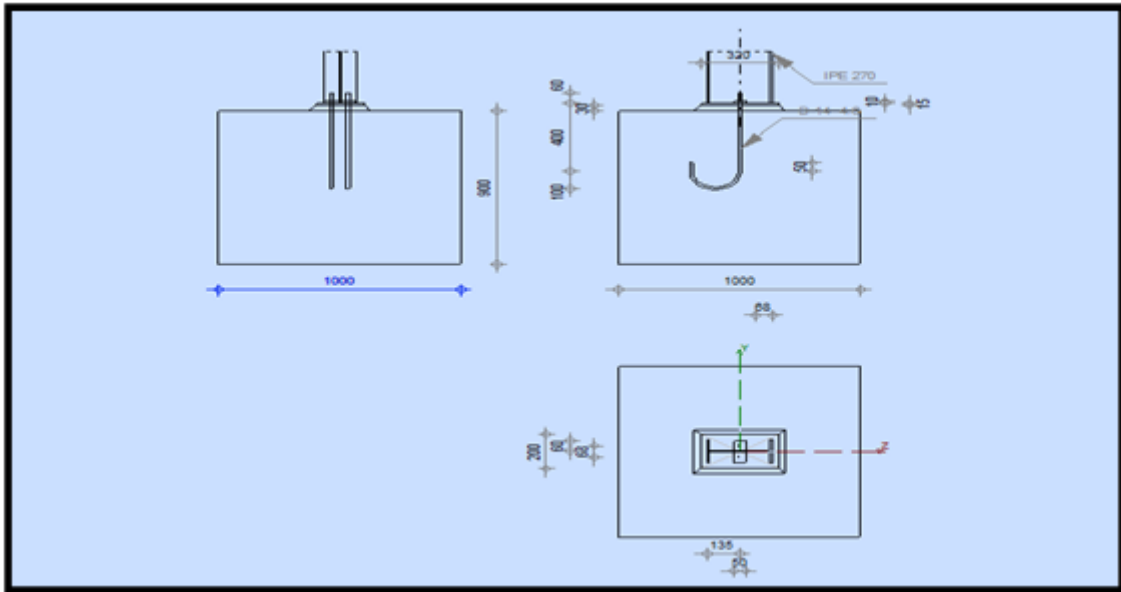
Vue en plan de l'assemblage pied de potelet
